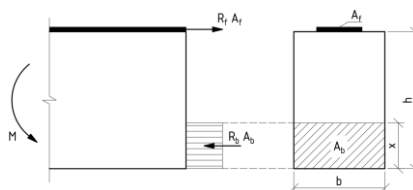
Схема усилий и эпюра напряжений в надопорном сечении с внешним армированием
